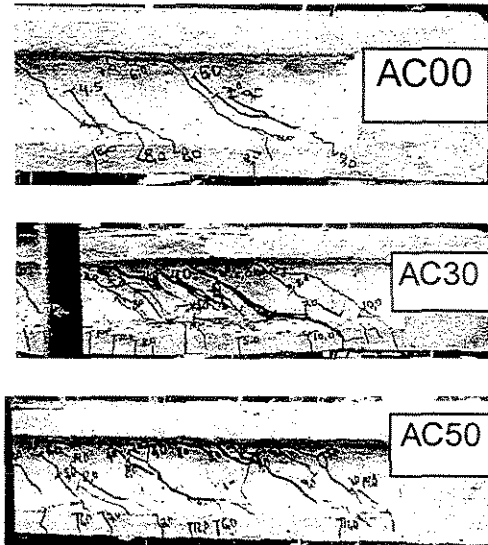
Fissuras na região próxima ao apoio das vigas AC
